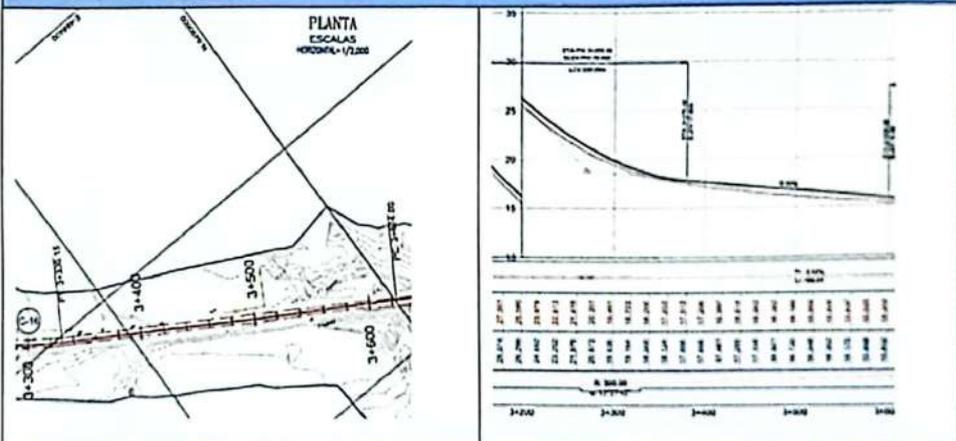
Vista en planta del tramo verificado (extraído del PP-004)
